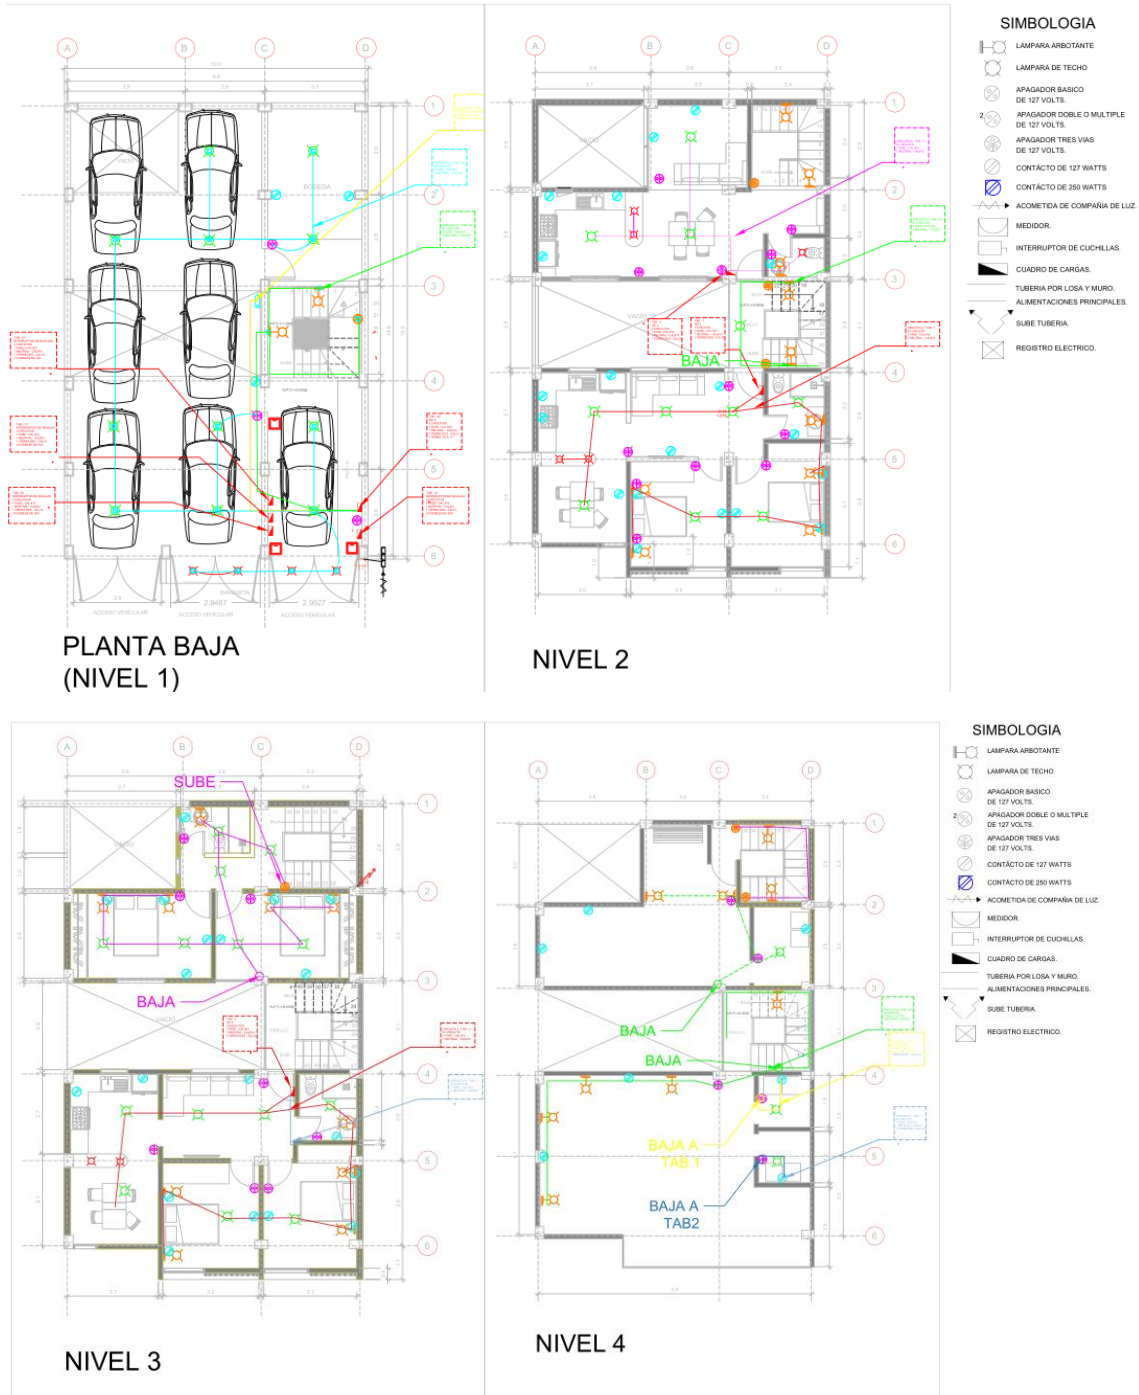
Planos de planta de propuesta 3, Elaboración propia, REVIT, 2023.
